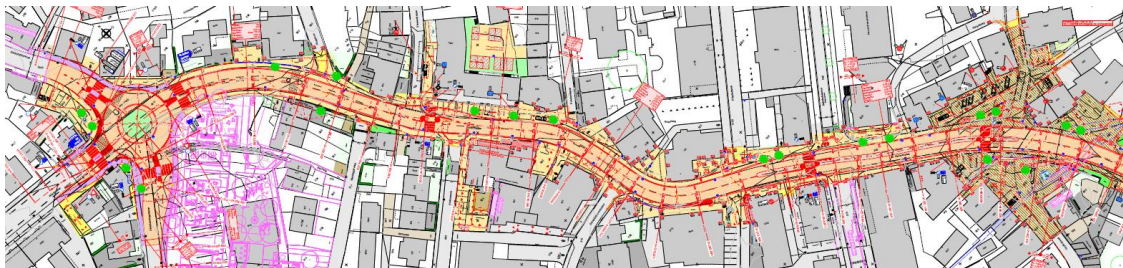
Situation Kantonstrassenprojekt; Genehmigungs- und Auflageprojekt; 11.01.2023
